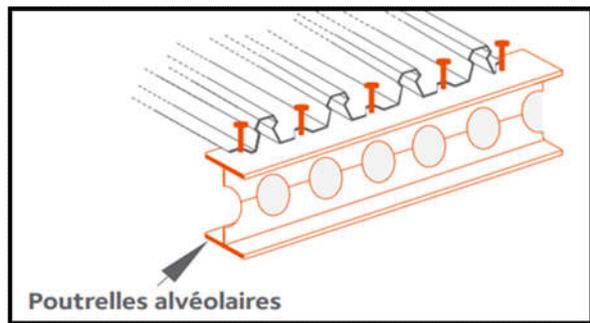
Jonction poutrelles et plancher collaborant. Source : ArcelorMittal Europe
